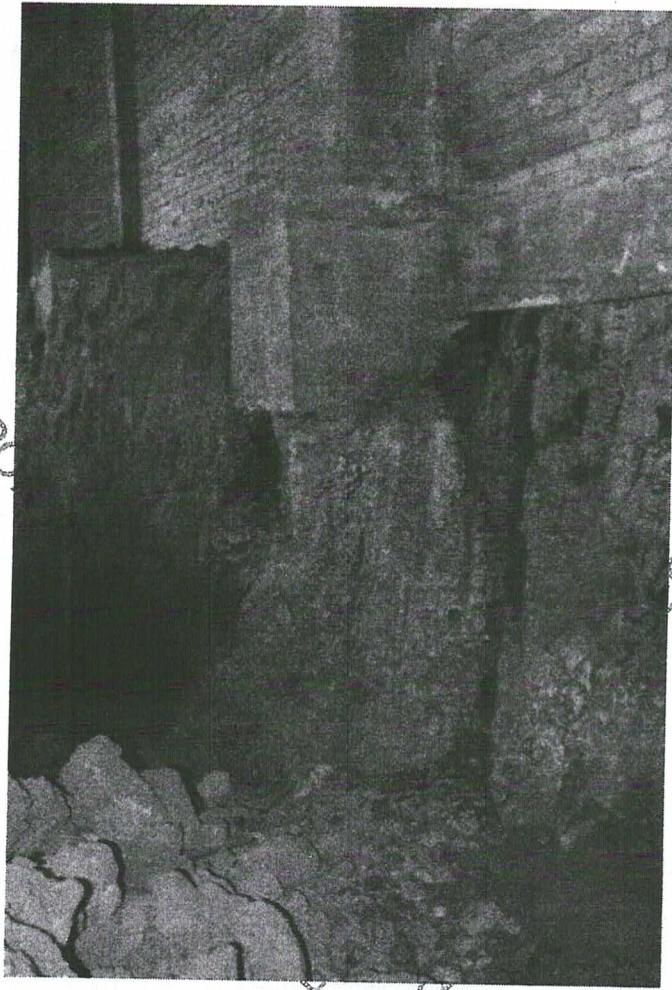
Vista de partes dos elementos estruturais das fundações
